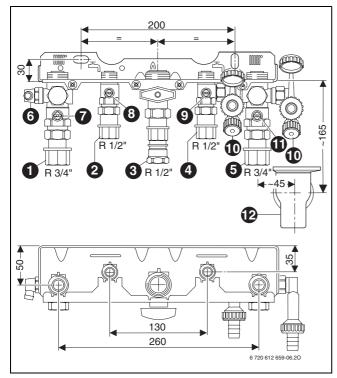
Beispiel: Montageanschlussplatte 7 716 050 156 Aufputz (Deutschland)
